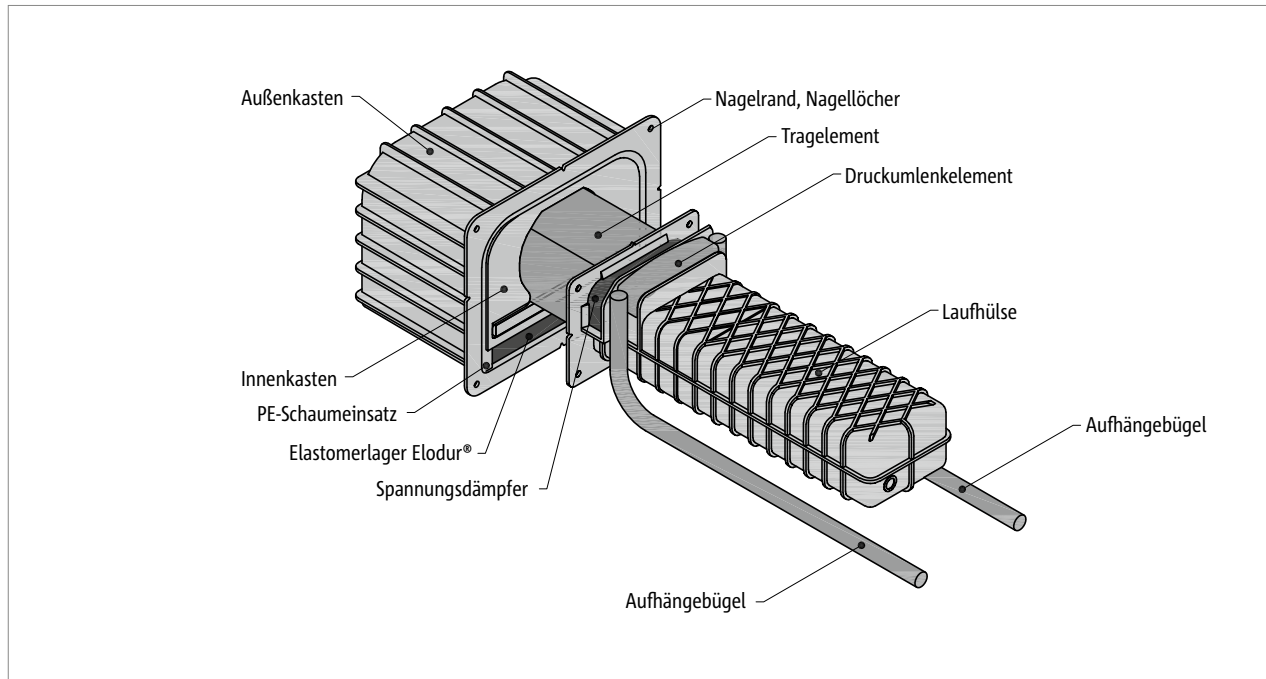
Schöck Tronsole® Typ Q: Wandelement, Tragelement und Laufhülse mit detaillierter Benennung wichtiger Bestandteile
